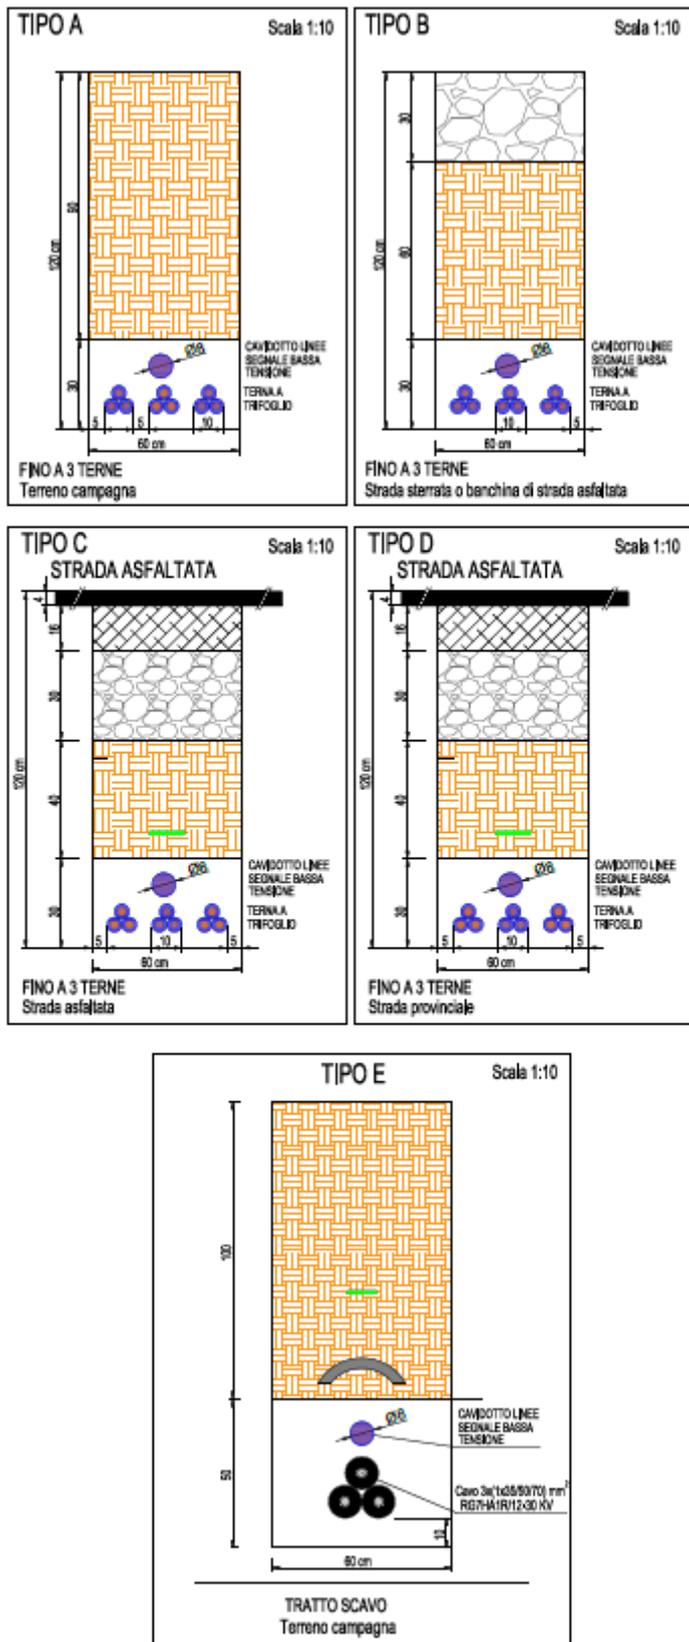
DETTAGLIO CAVIDOTTO MEDIA TENSIONE
